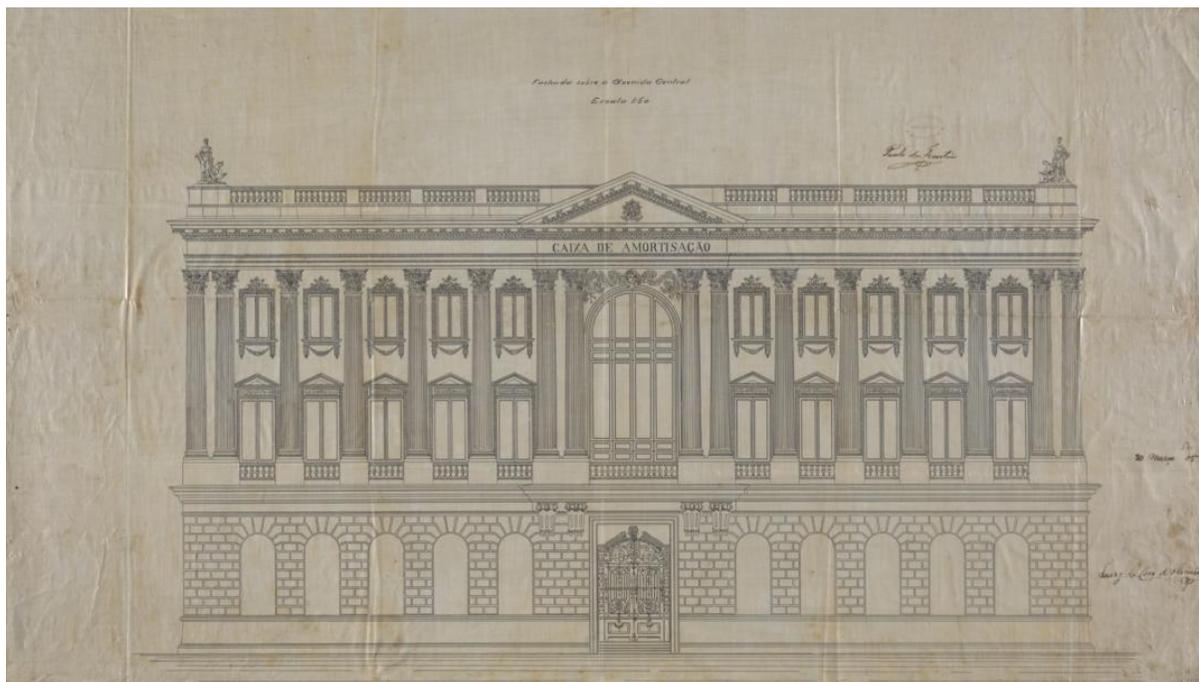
Fachada da Caixa de Amortização, 1905 (acervo Arquivo Nacional – Fundo Comissão Construtora da Avenida Central)
